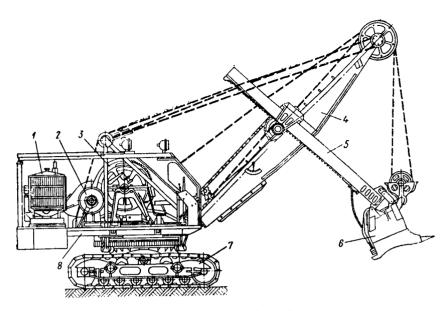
Экскаватор Э-1252Б: 1- двигатель; 2- механизм реверса; 3- главная лебедка; 4- стрела; 5- рукоять; 6- ковш; 7- гусеничный ход; 8- поворотная платформа
